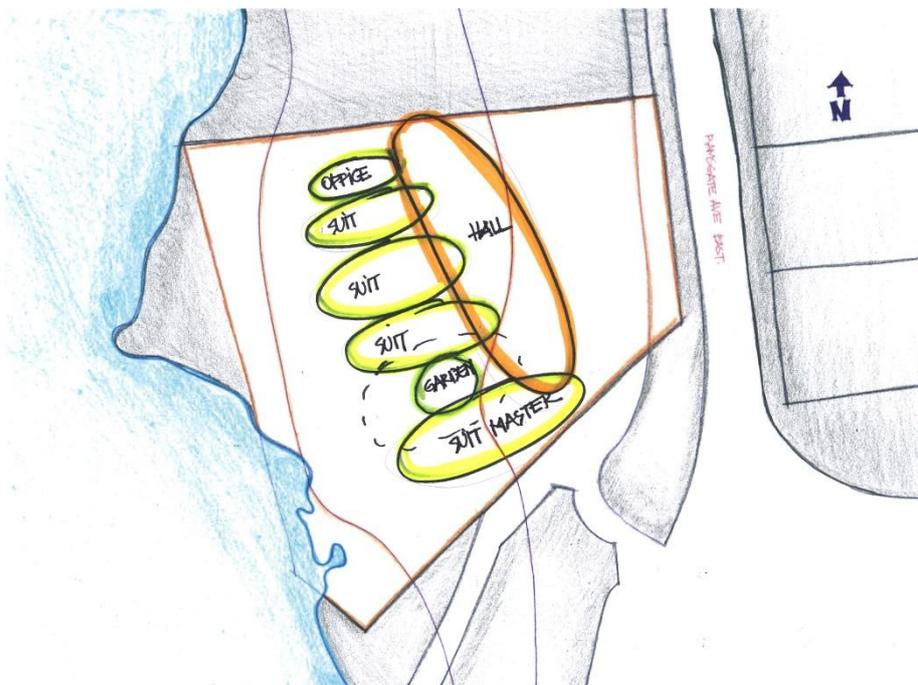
Croqui do estudo inicial de massas para a residencia, pavimento superior.
